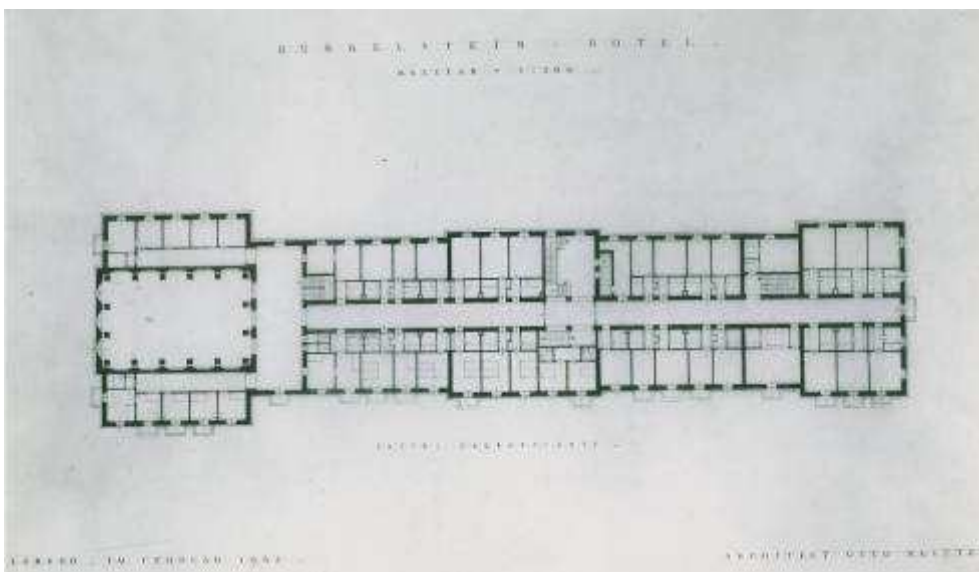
Otto Reitter, Grundriss, 1. Obergeschoss, *Bürgelstein-Hotel*, Salzburg, Februar 1943 (Sammlung Ostheim).
